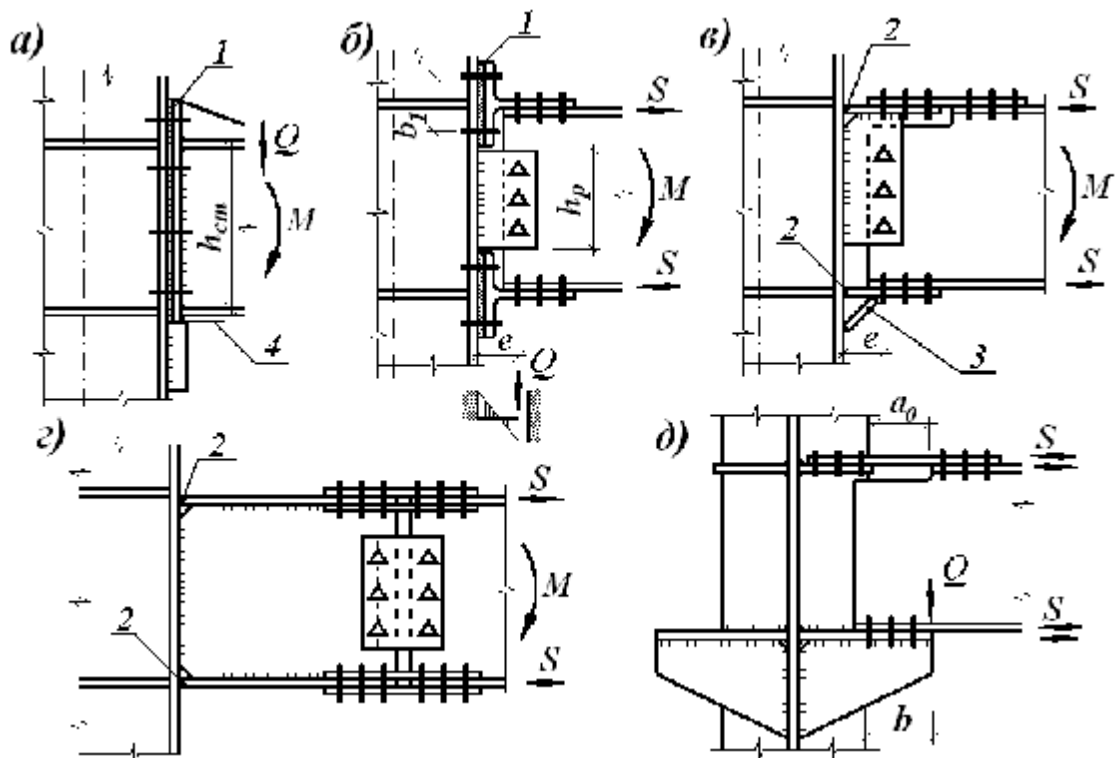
Жесткое крепление балки двутаврового сечения к колонне на болтах. а – в – крепление к полке колонны; г – крепление с выносным стыком; д – крепление к стенке колонны. 1 – прокладка; 2 – заводской сварной шов; 3 – подкос из листа; 4 – плоскость обработки.
